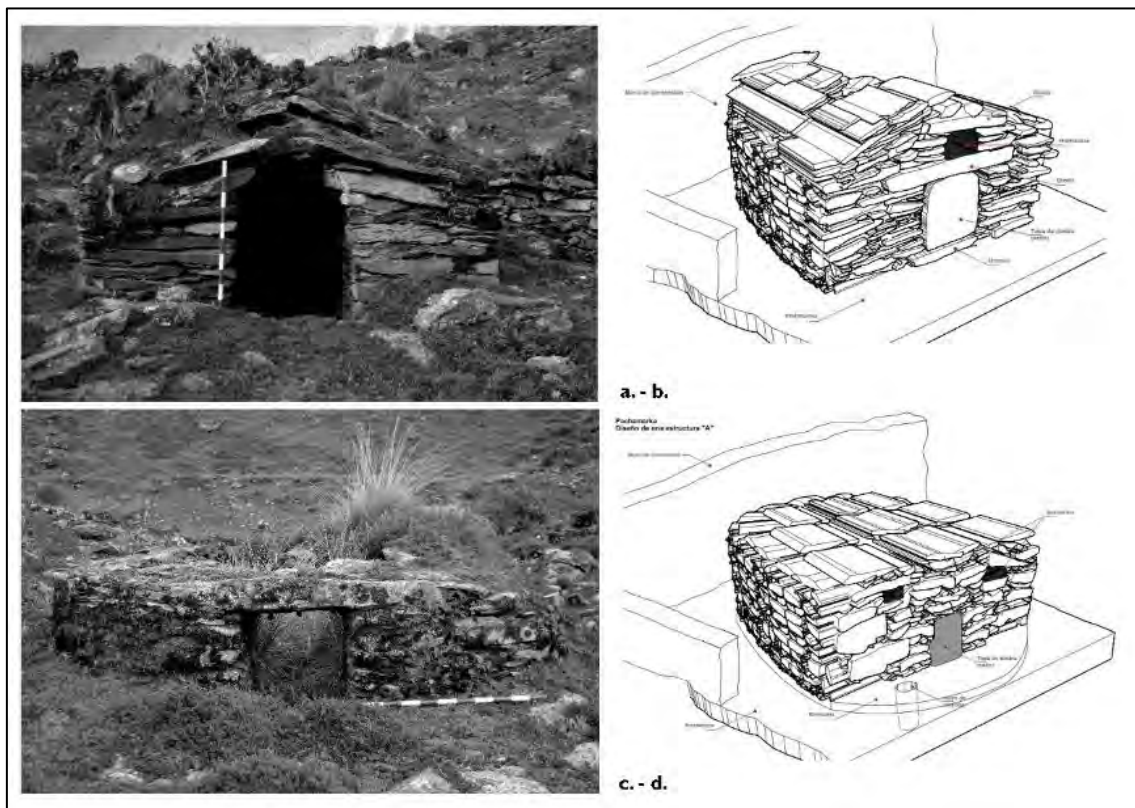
Las dos soluciones del techo en Pachamarka; a, foto de una estructura con techo tipo falsa bóveda; b, reconstrucción isométrica; c, foto de una estructura con techo tipo plano; y, d, reconstrucción isométrica (elaboración propia).
